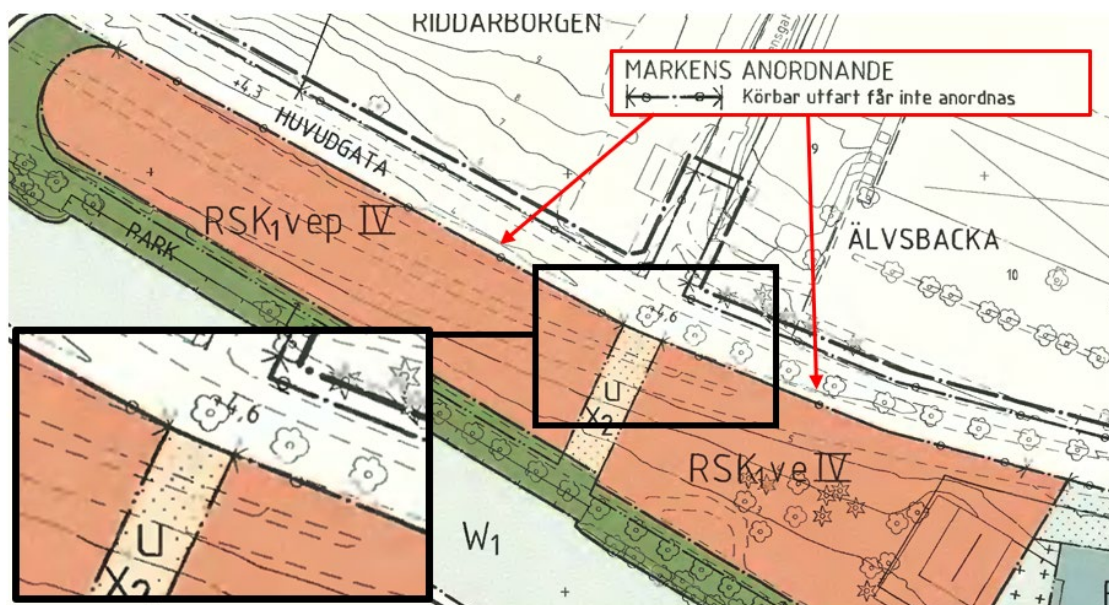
Illustration på plankarta för gällande detaljplan. Illustrationen tas bort i samband med aktuell ändring.
